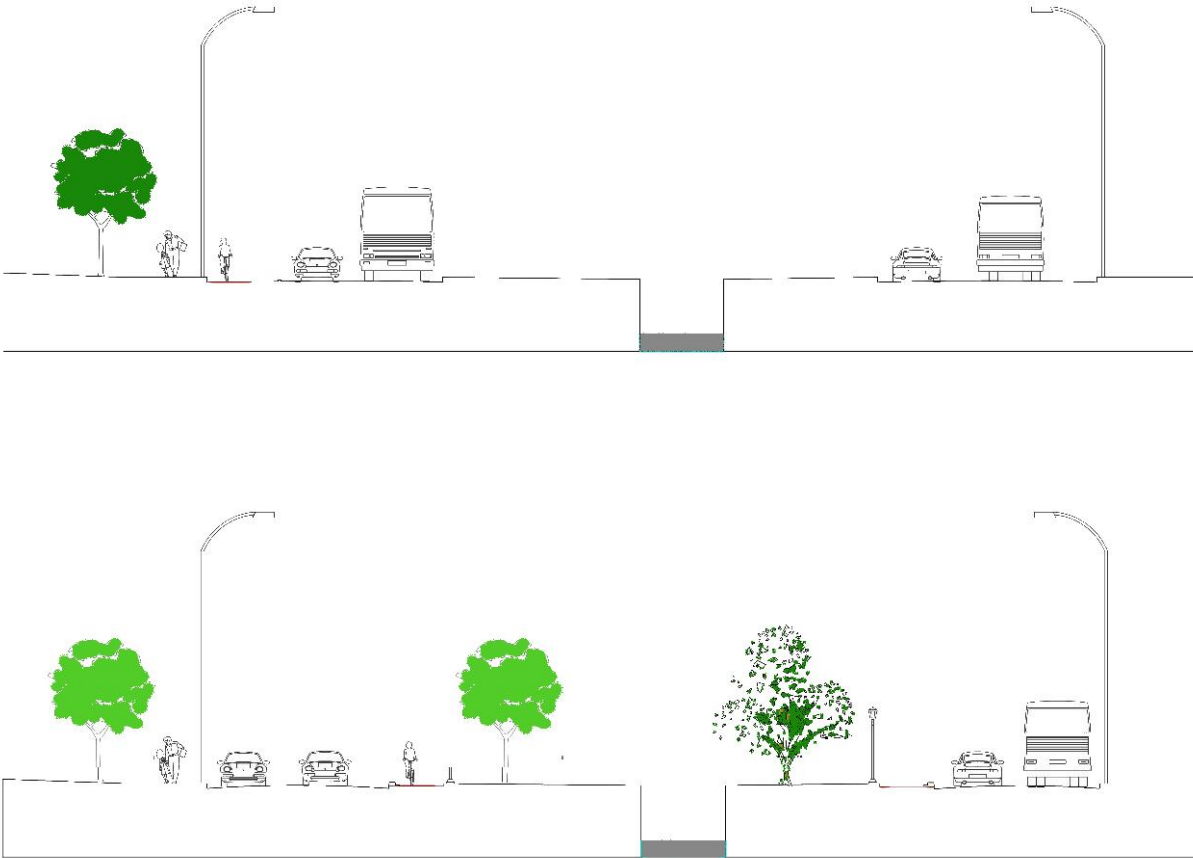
Acima, situação atual do trecho da chaminé. Abaixo, projeto proposto.
